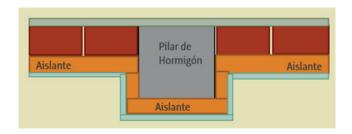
Solución del puente térmico en el encuentro con el pilar
